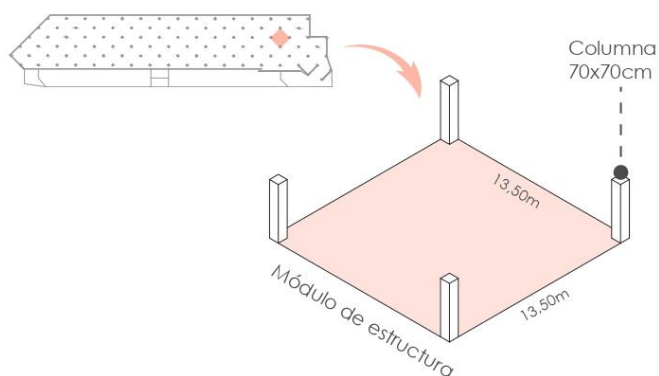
Trama Estructural del Terminal Terrestre de Cumandá
